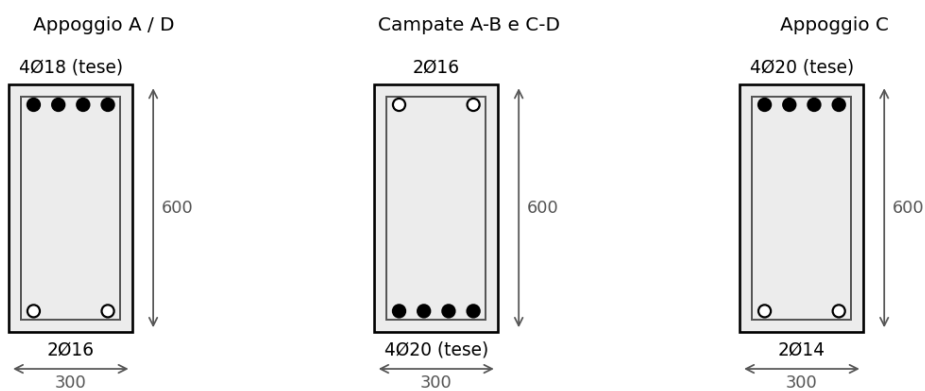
Sezioni tipo della trave 30 × 60 con le armature adottate.
